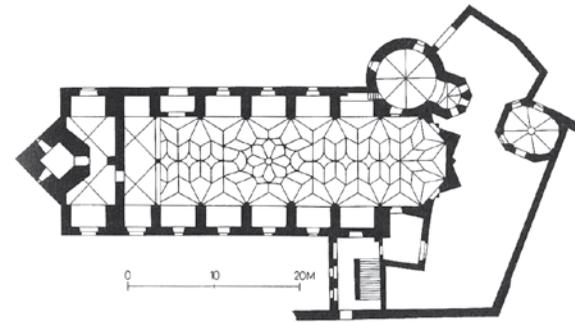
Grundriss der Kirche mit dem nordöstlich integriertem Karner. Dehio Niederösterreich 1990, 863.
